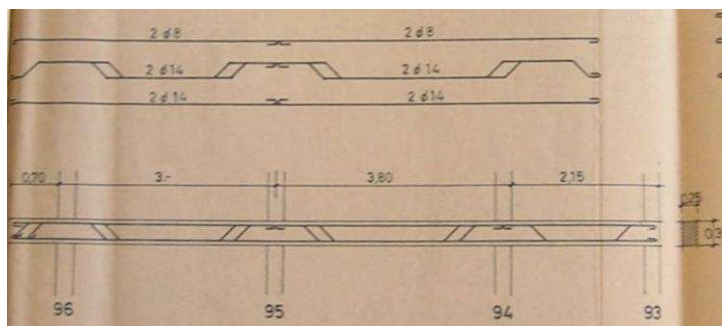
Despiece de armaduras de vigas. Edificio ficha 177C.017, 1962
